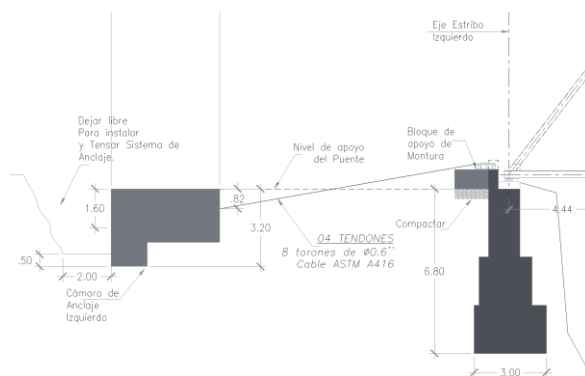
Sistema de cables para el desmontaje del Puente Chupuro
